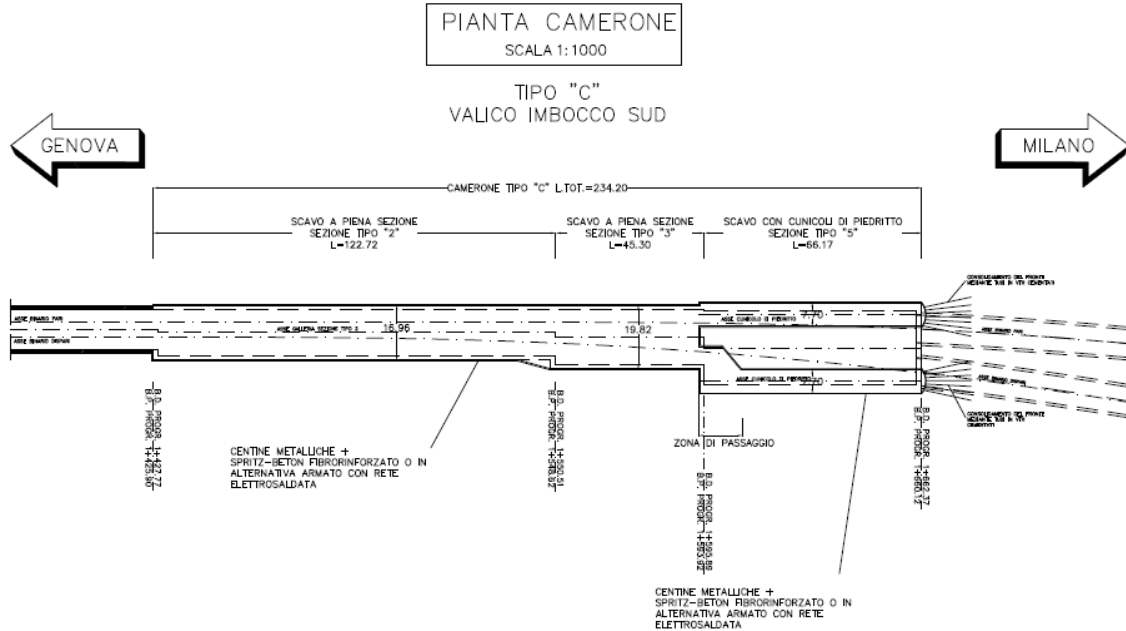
Sezioni tipo camerone previste da Progetto Definitivo
